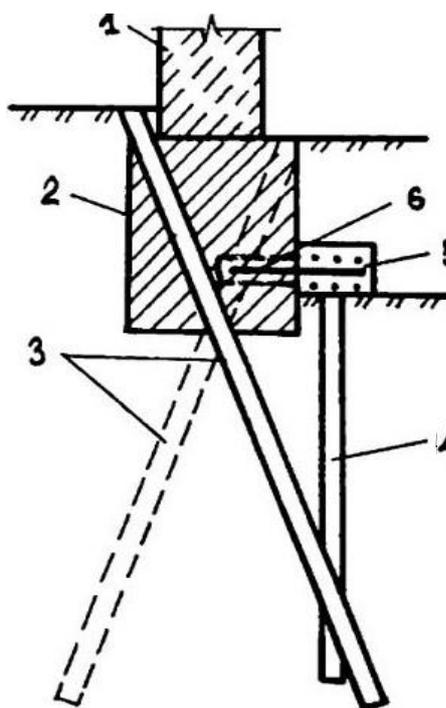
Схема усиления фундаментов буроинъекционными сваями: 1 – стена; 2 – фундамент; 3 – наклонные сваи; 4 – вертикальная свая; 5 – ростверк; 6 – скважина для крепления анкером ростверка
